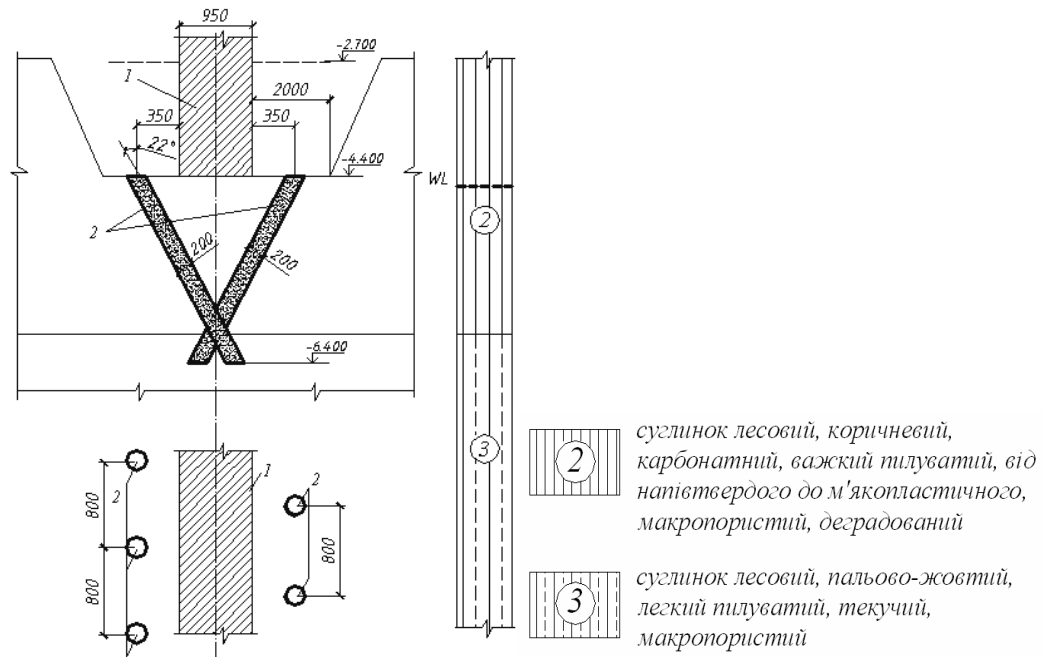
Схема підсилення основи існуючого фундаменту:
